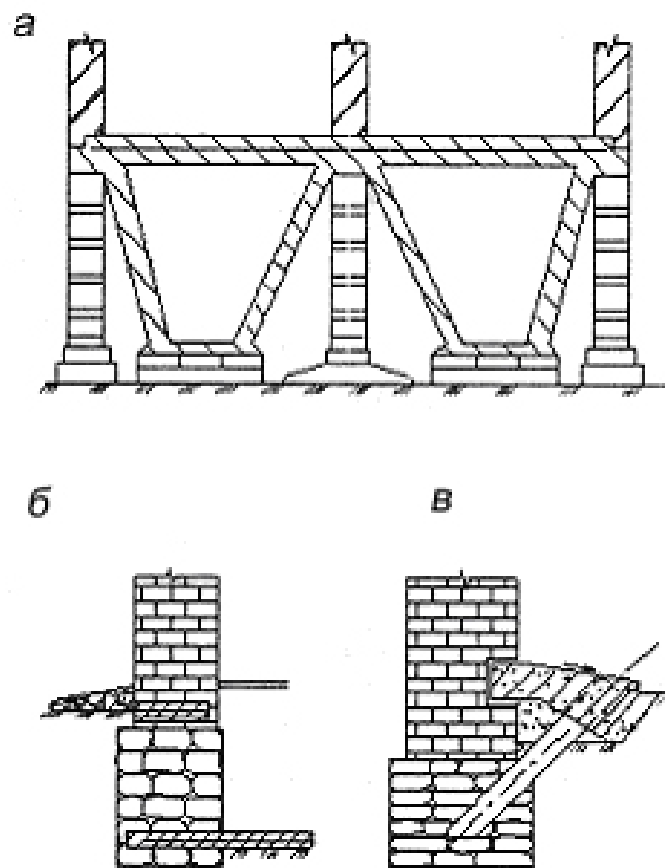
Удосконалені методи підсилення фундаментів на основі традиційних: а – конструкція з збірних або монолітних рам у підвалі; б, в – виносні консолі і плити
